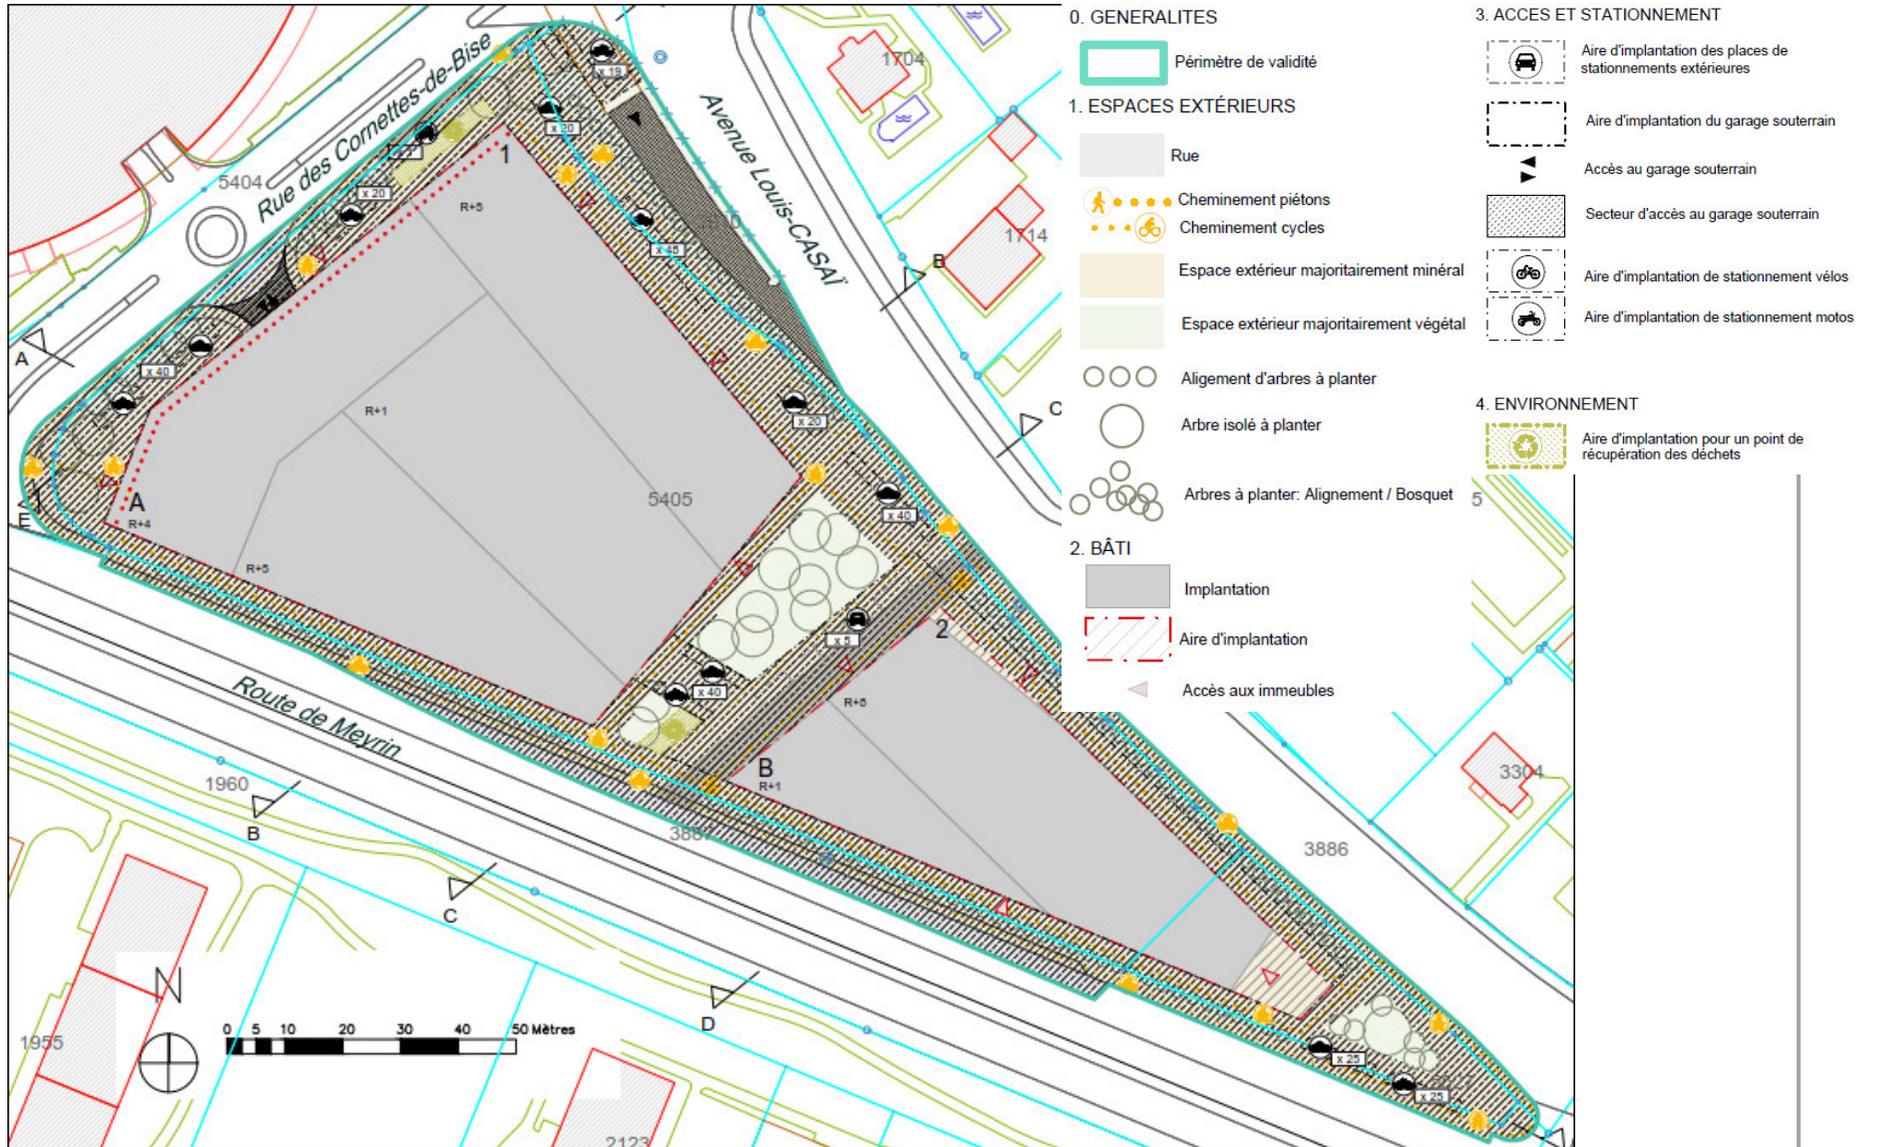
Plan d'aménagement du PLQ « Pointe du Bouchet »
